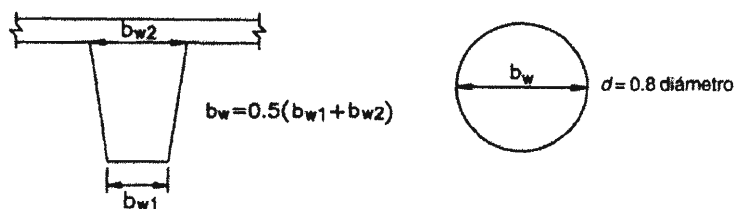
Parámetro b_w para el cálculo del refuerzo mínimo de corte en secciones trapezoidales y circulares
